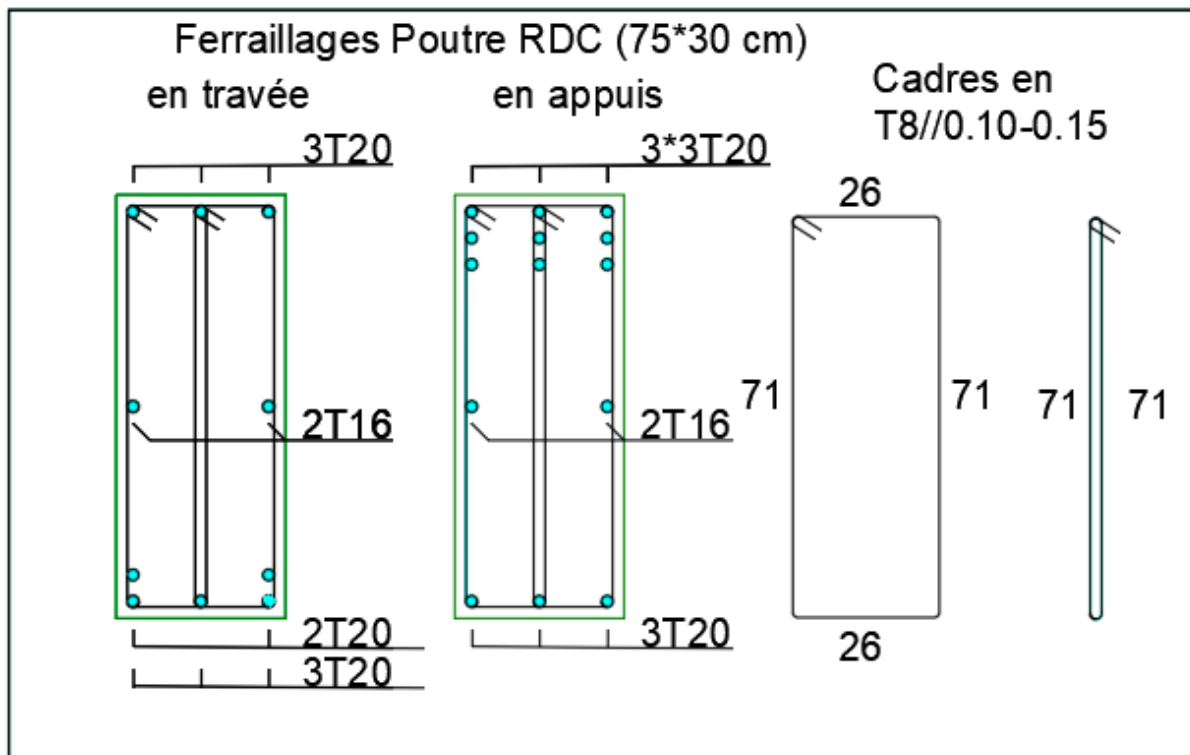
Ferraillages Poutre RDC 75*30 cm.
